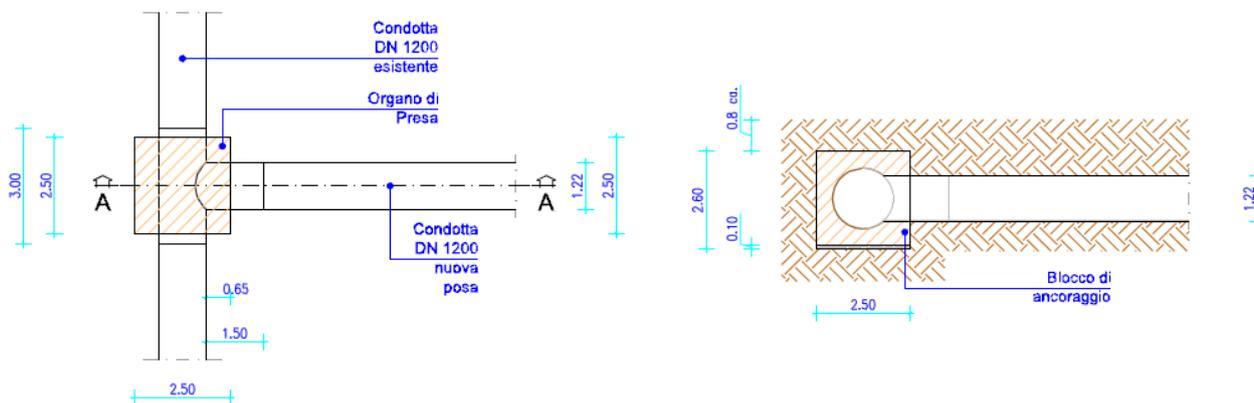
Organo di presa: particolari costruttivi della pianta (a sinistra) e della sezione (a destra)
